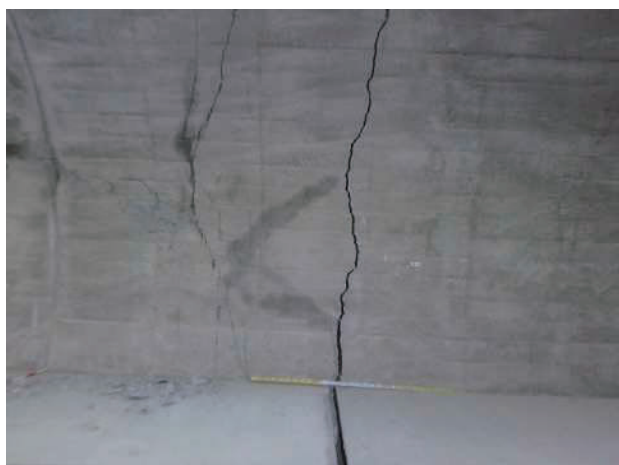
覆工全周にわたる輪切り状ひび割れ
